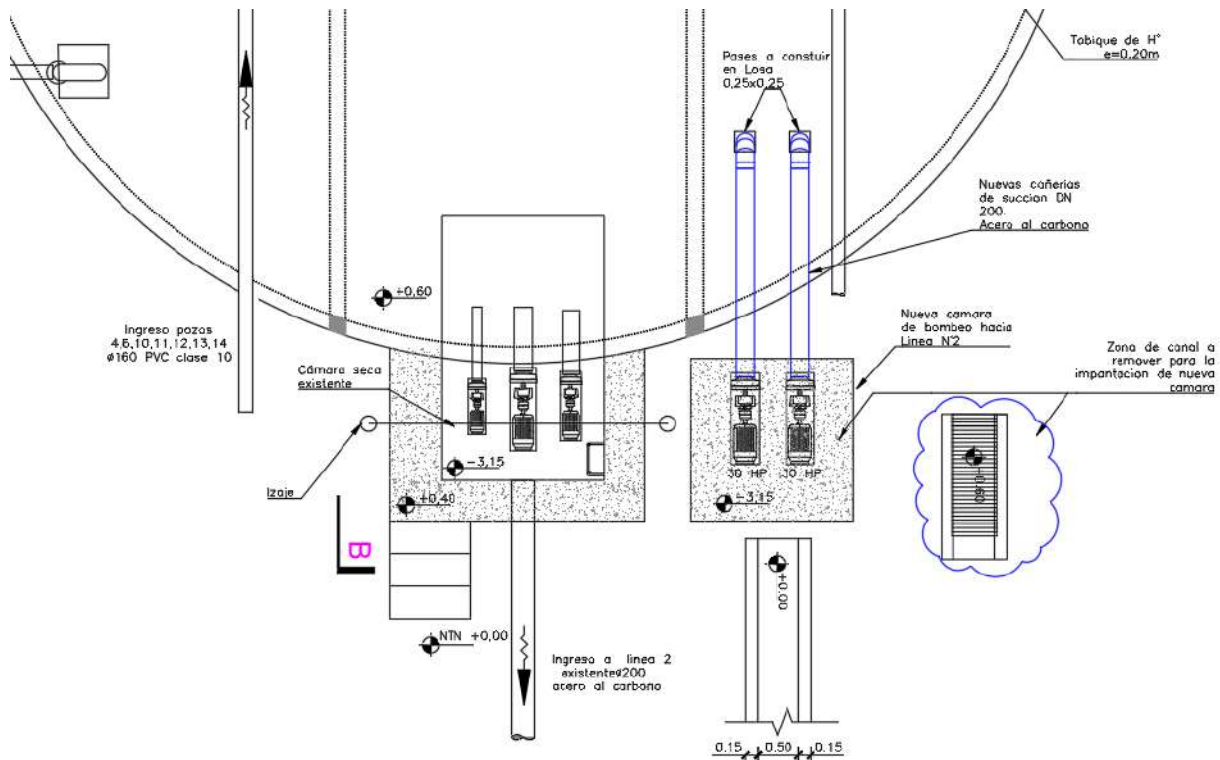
Diseño del nuevo sistema de bombeo en Planta – Fuente de elaboración propia
